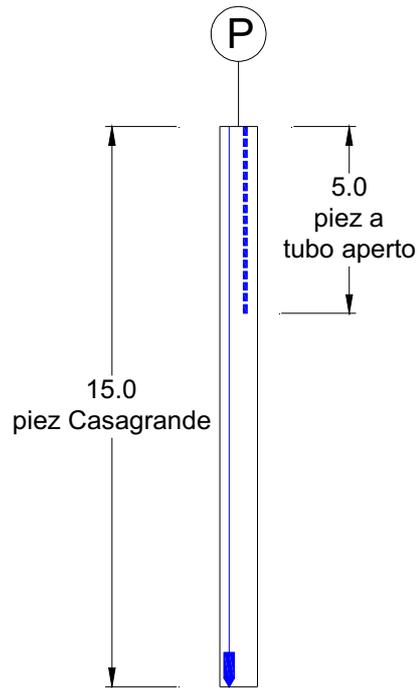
\_ Schema installazione piezometri nella singola verticale Pi.
